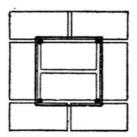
Внутренне вертикальное армирование кирпичной кладки
